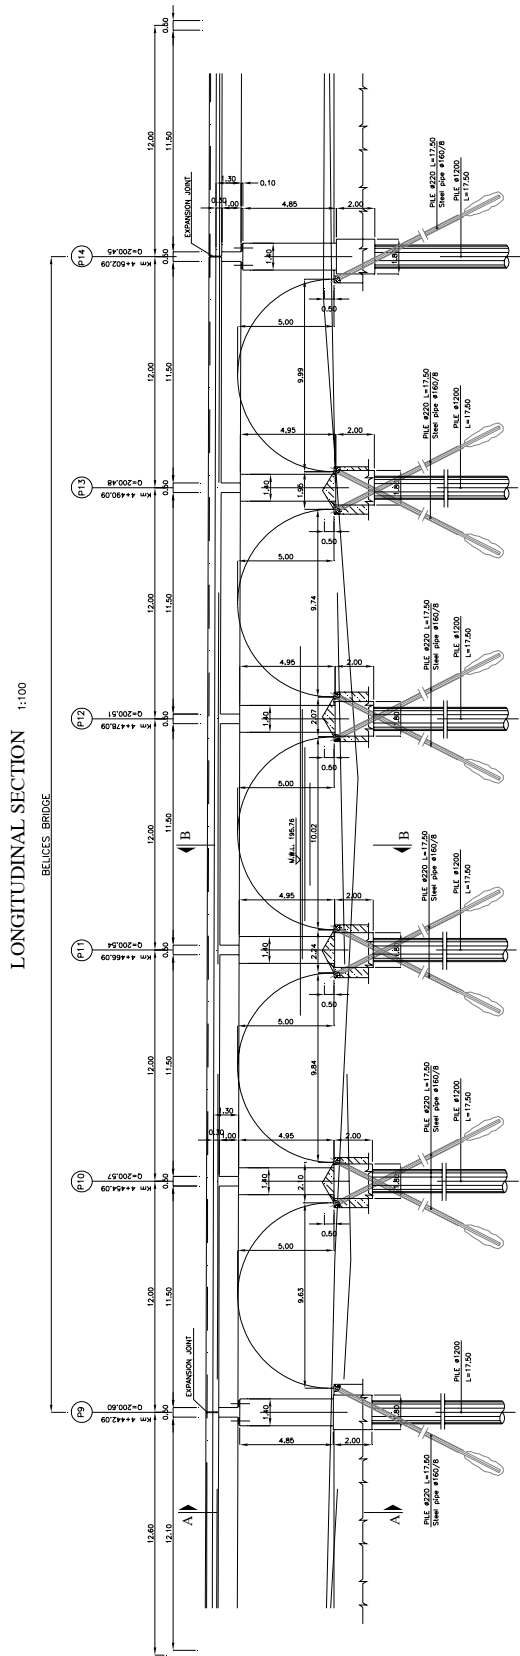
Progetto di adeguamento statico del Belices Bridge: prospetto longitudinale del ponte.
